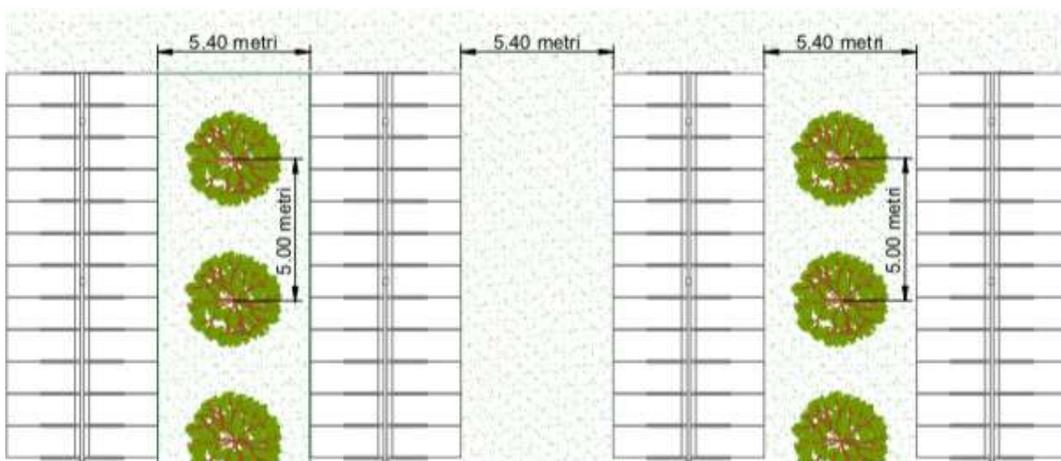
Vista in pianta della disposizione dell'oliveto a file alterne
